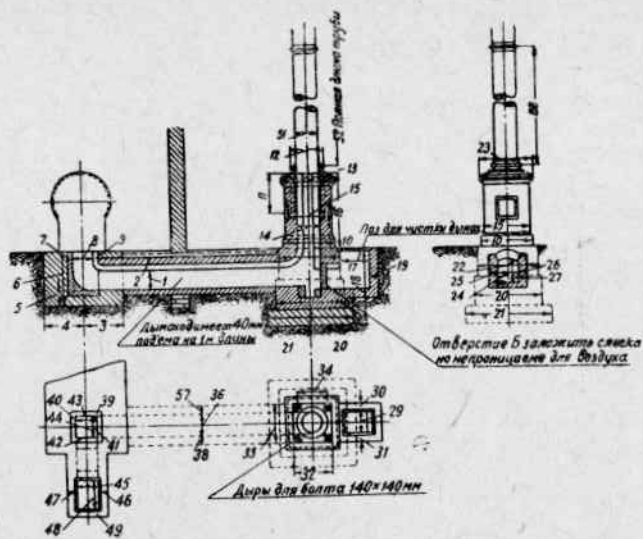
Установка дымовой трубы и дымохода для Людиновского локомотива.
